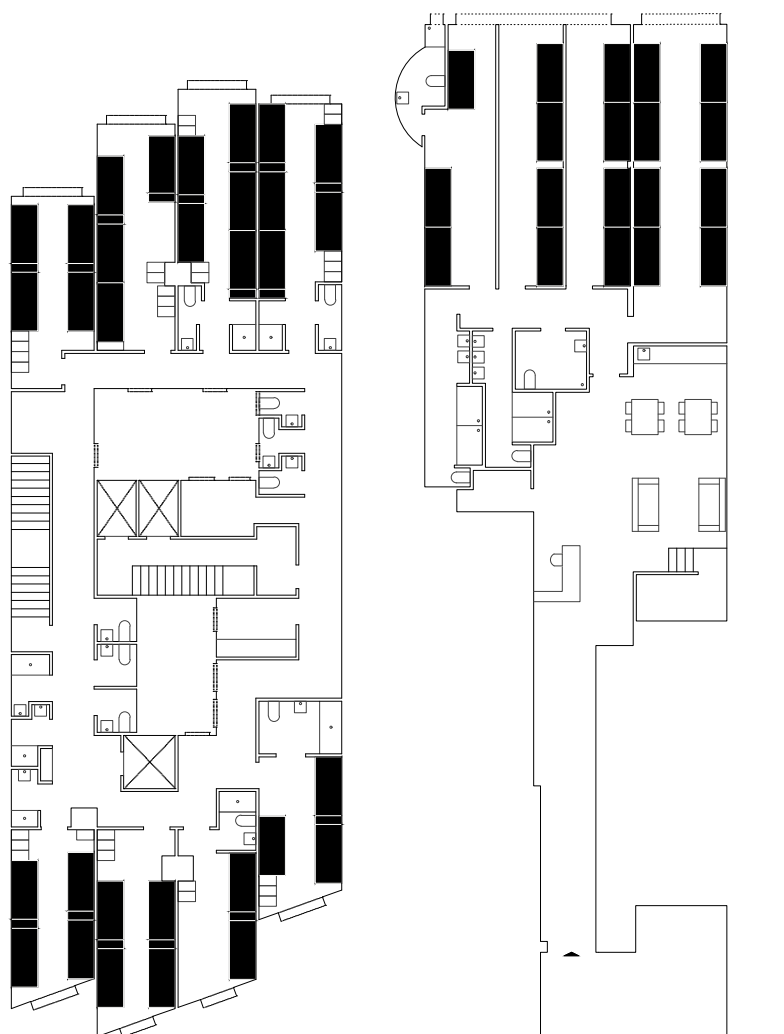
Plantas de *hostels* que ocupan parte de edificaciones existentes e incluyen la planta baja. *Sant Jordi Sagrada Família*, 2010-2016, planta primera (izquierda) y *Rocket hostel*, 2013, planta baja (derecha).
